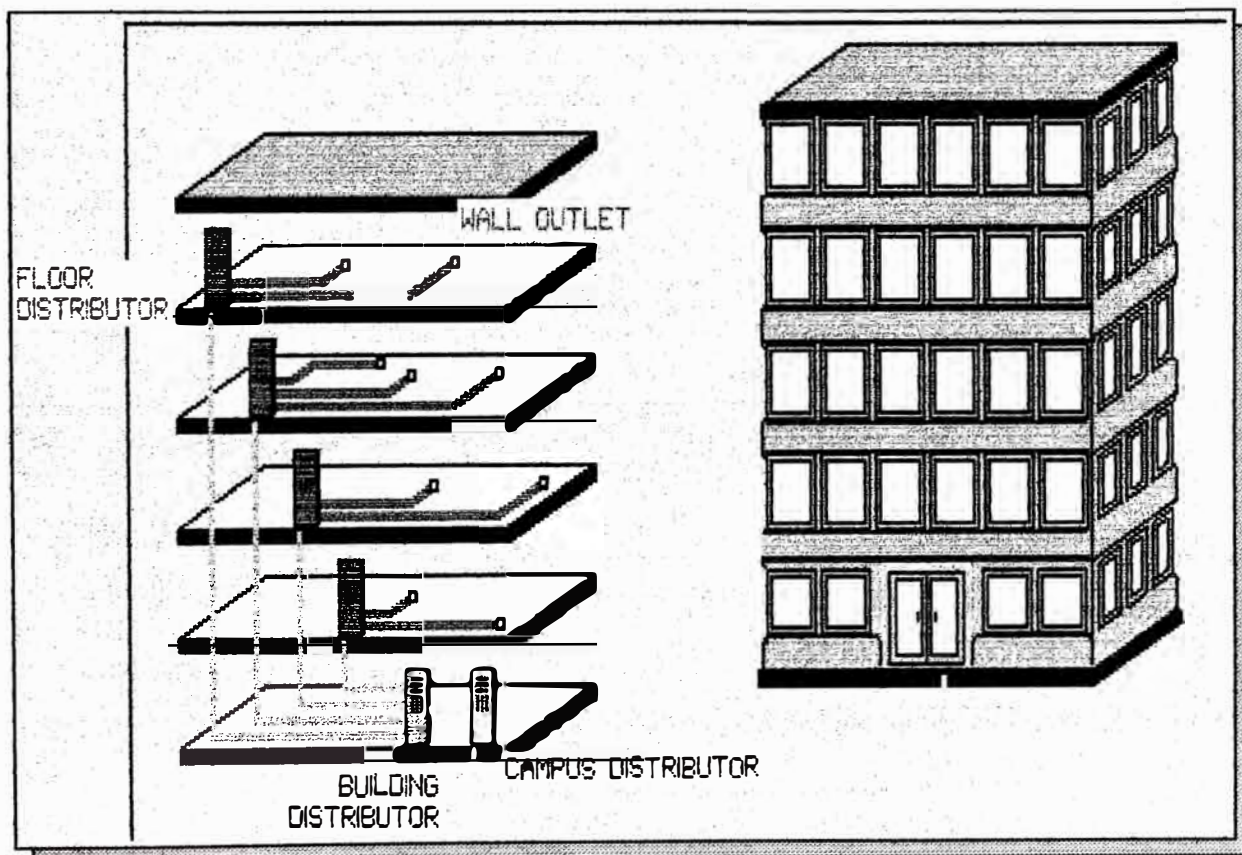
Estructura jerárquica de un Sist. de Cableado Estructurado
